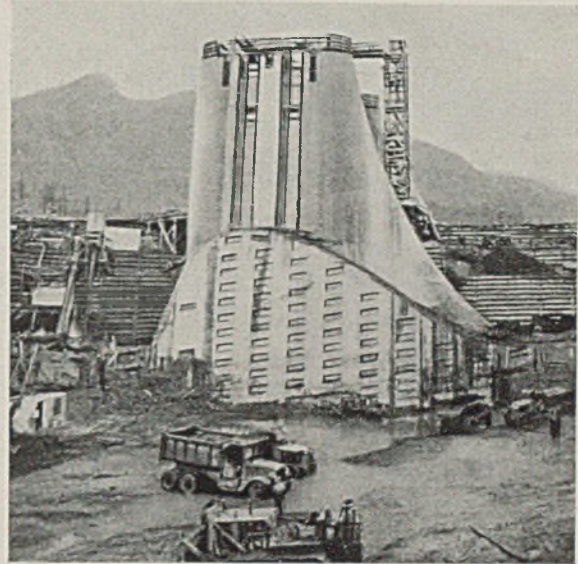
Bonneville-Stauwehr, USA. Grundwehrrufe mit Pfeiler-
